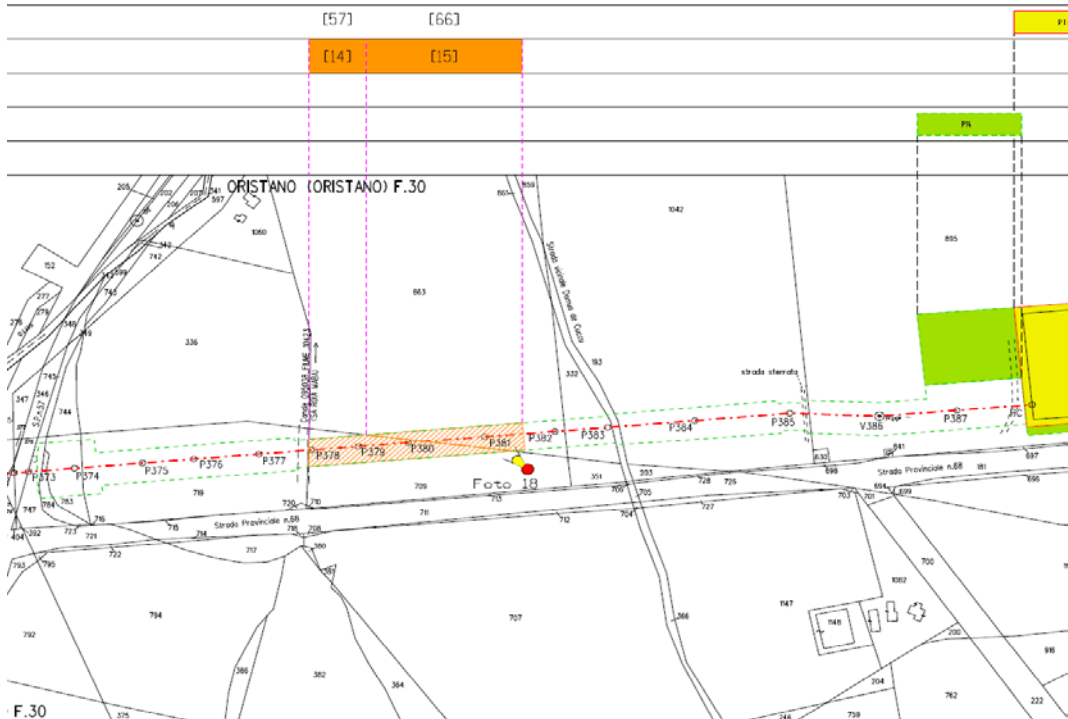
Tratto P378 - P380+10mt; P380+10mt – 381+31mt - la zona delimitata dalle linee verdi rappresenta la fascia ristretta di lavoro per come previsto dalla GASD C 13.40.10.02
